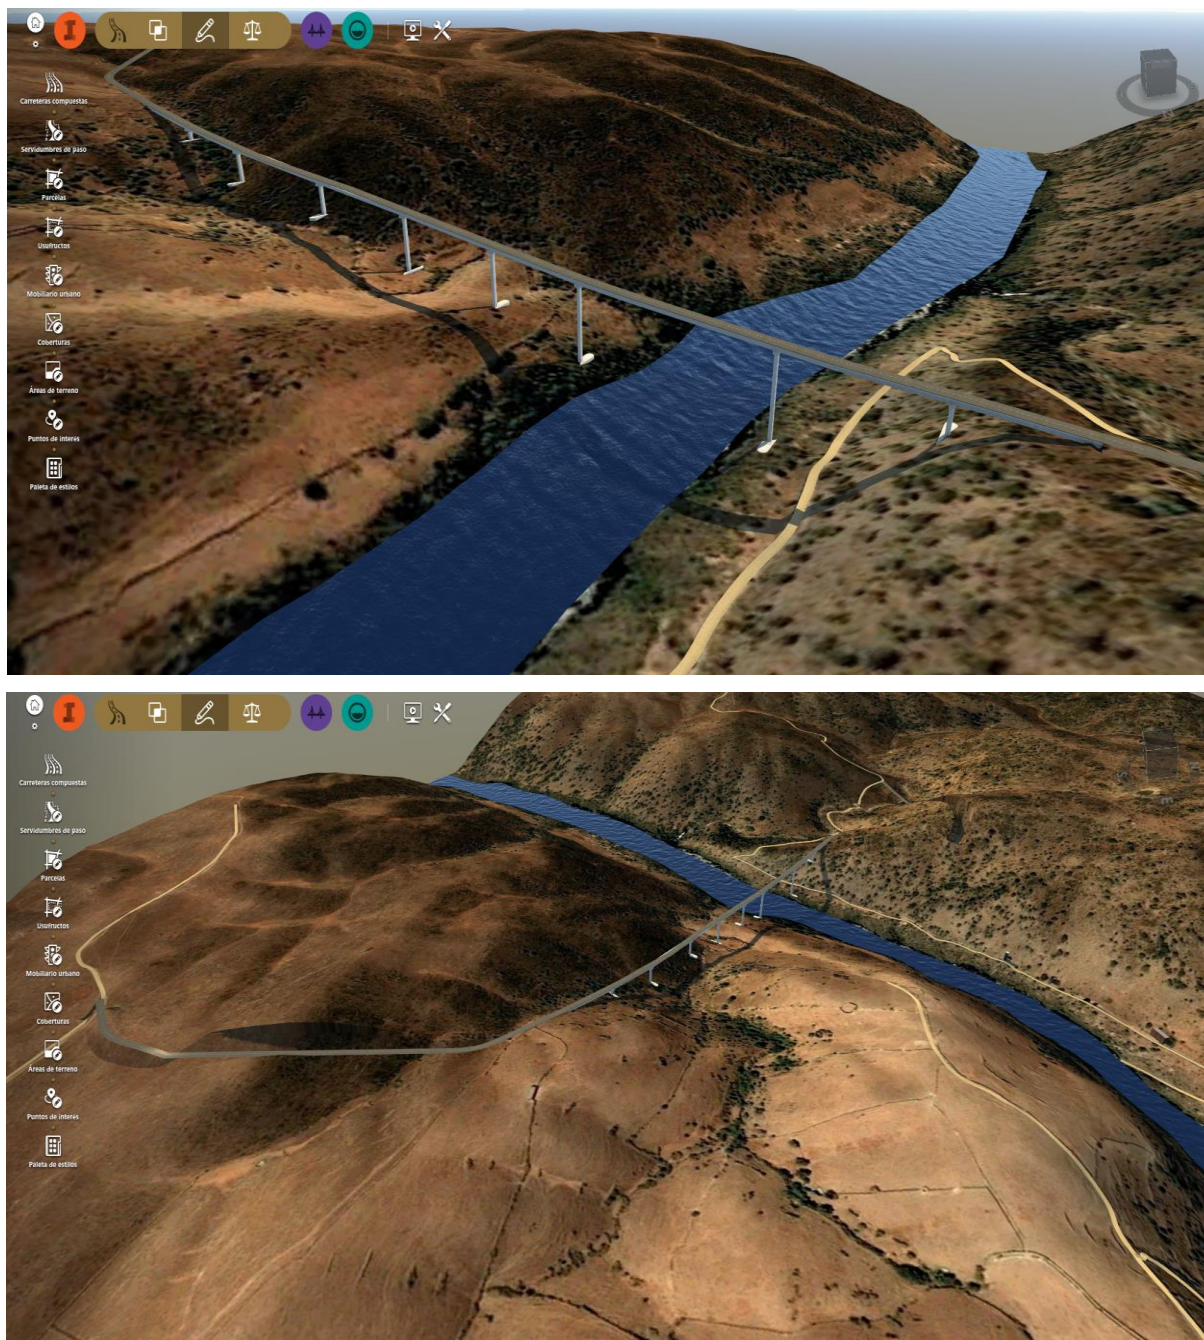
Alternativa 1 en InfraWorks 360.
